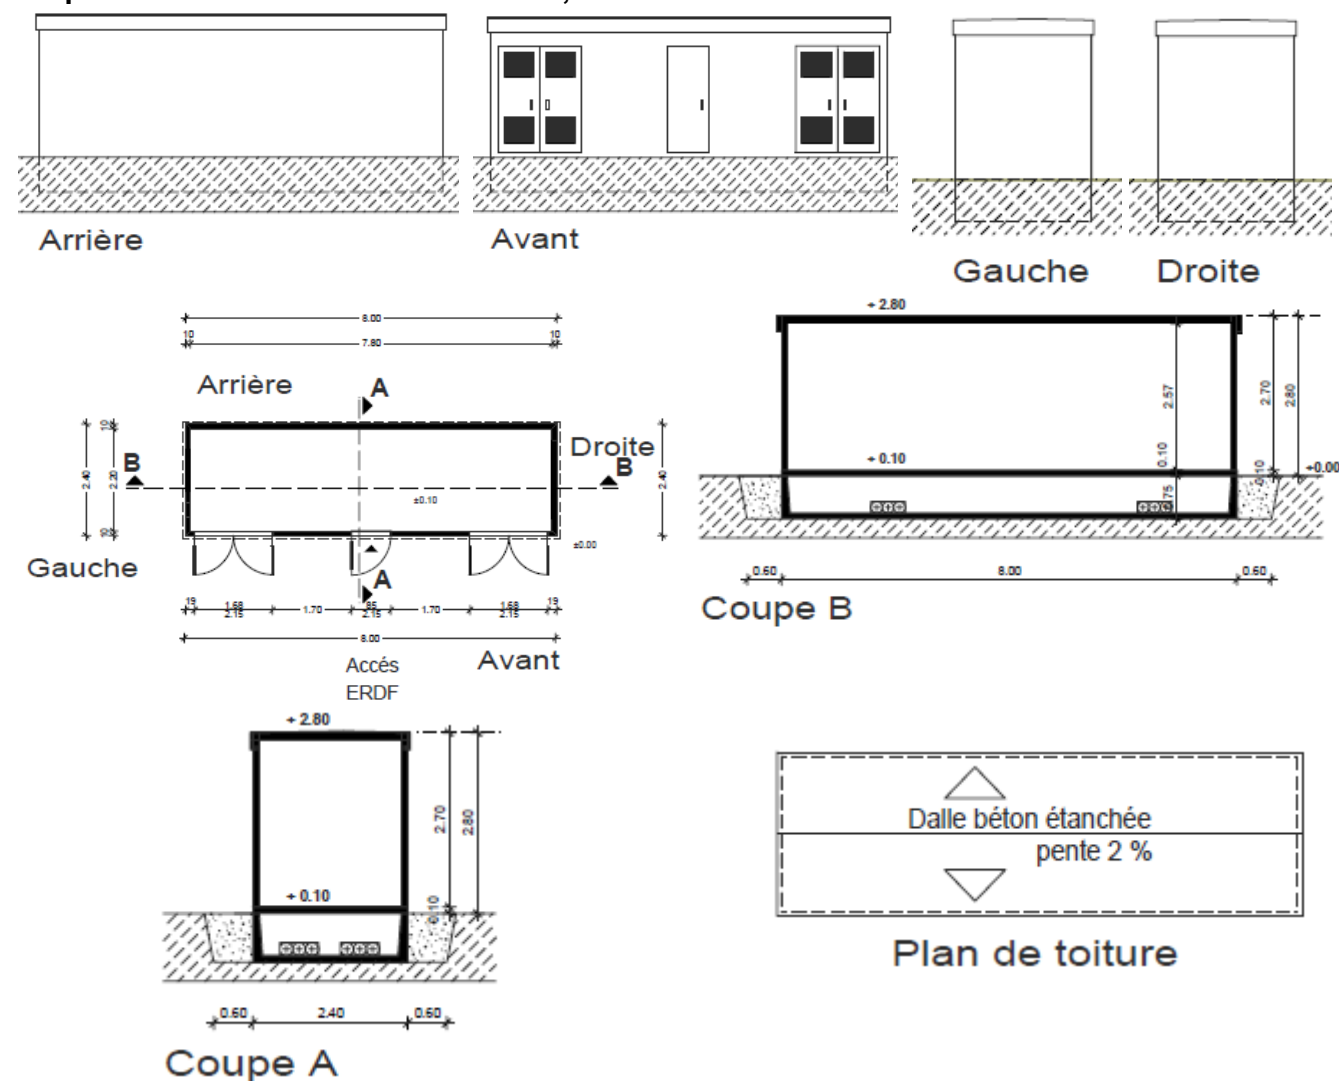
Vues des façades du poste de livraison prévu sur site (source : AD Agence)
